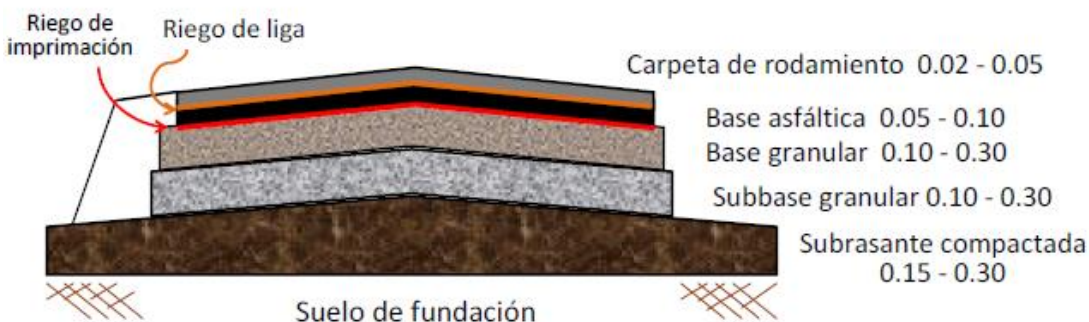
Perfil Tipo: Pavimento Flexible
